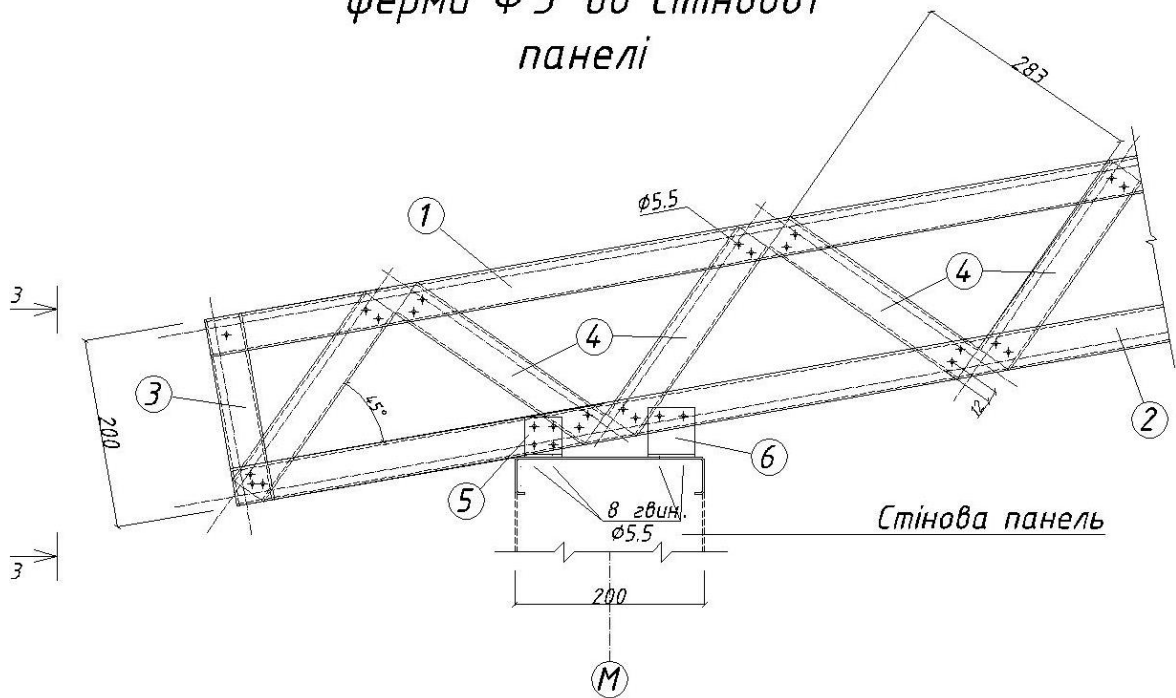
Вузол закріплення ферми Ф3 до стінової панелі
